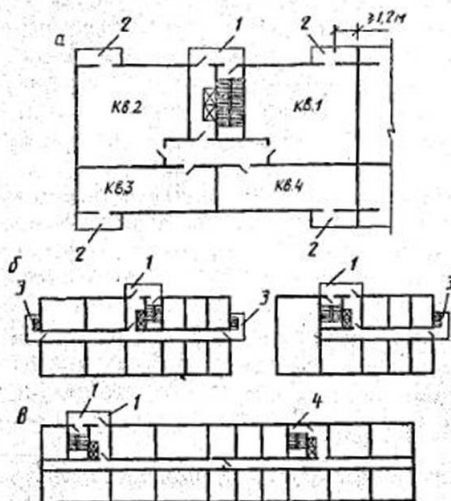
Схемы размещения лестничных клеток в жилых зданиях
